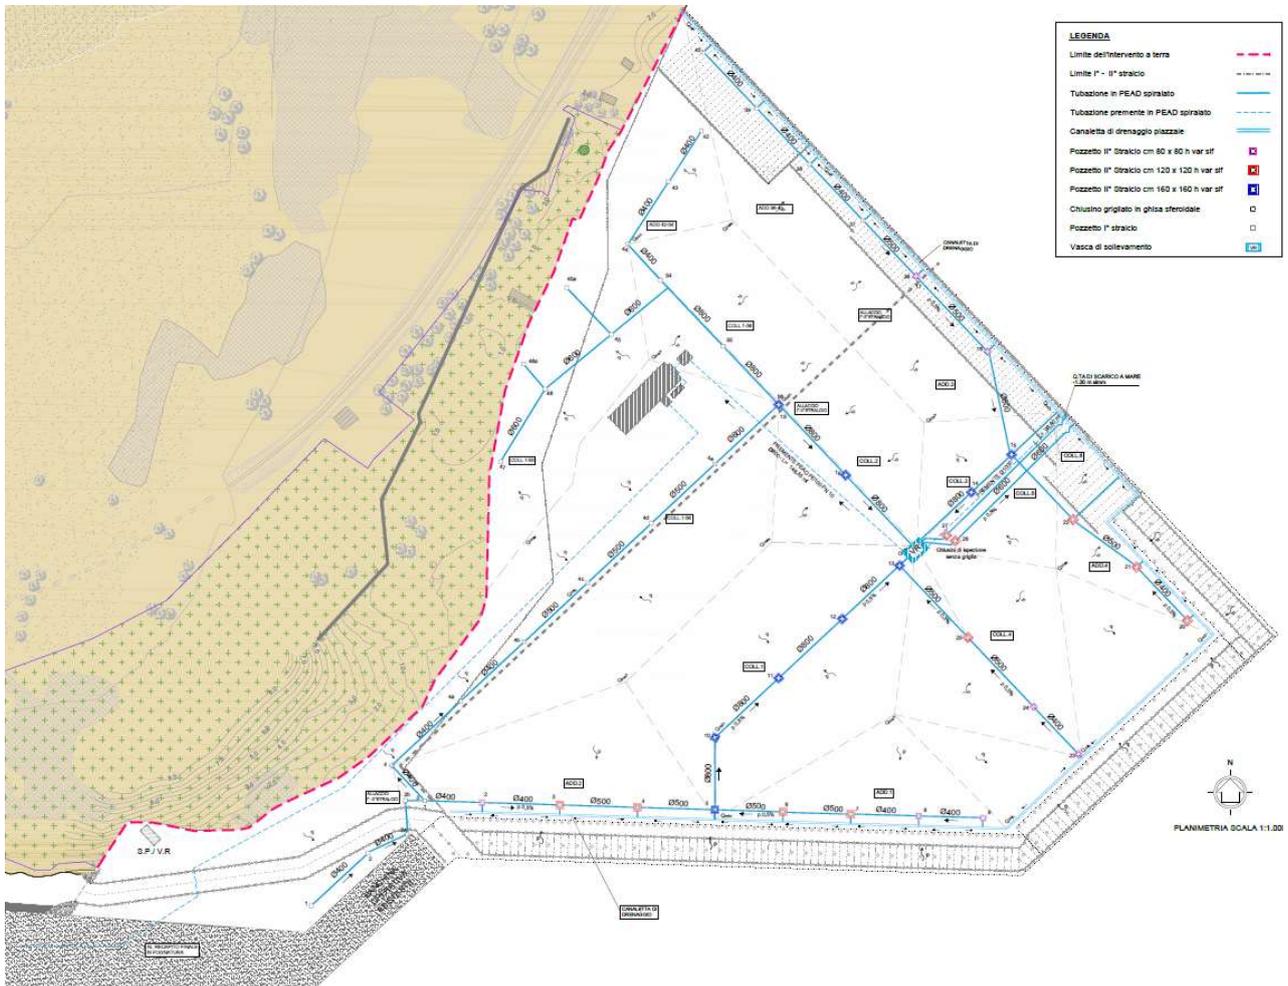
Planimetria rete idrica acque bianche - Perizia di Variante
